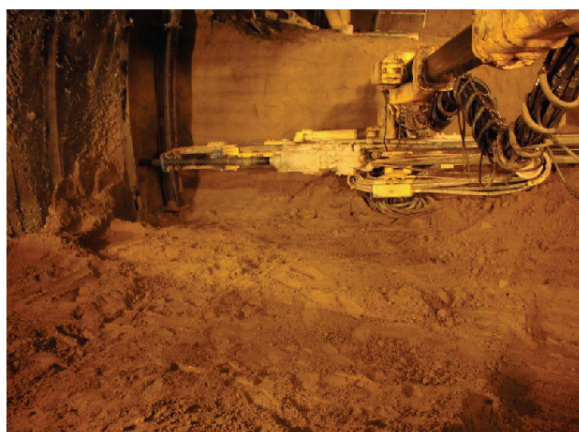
上半サイドパイル施工状況（牛鍵トンネル）
